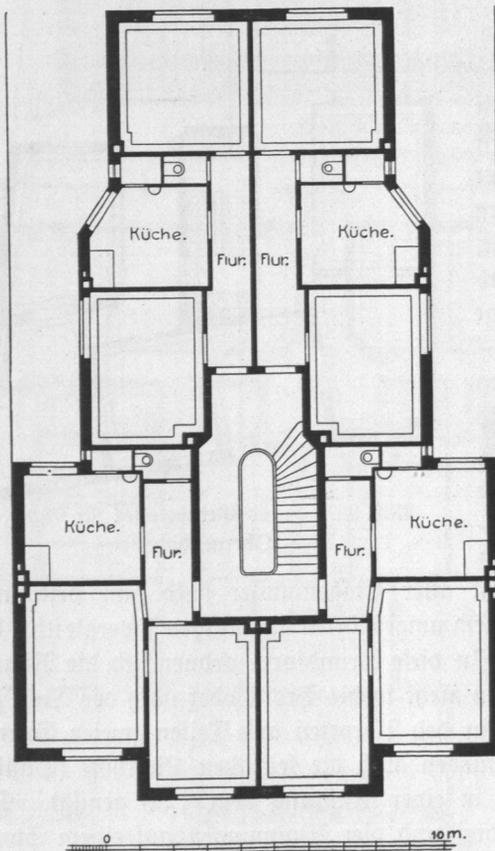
Haus Billstraße Nr. 107, Obergeschoß.
